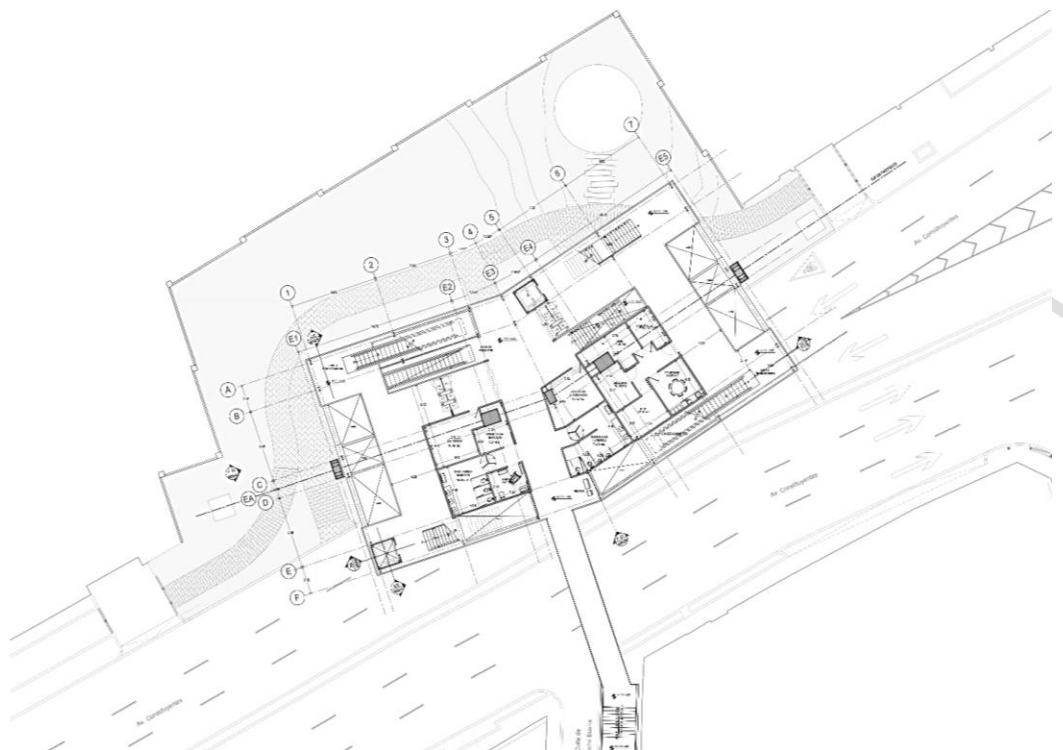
Planta primer nivel Estación 4 Lienzo Charro
